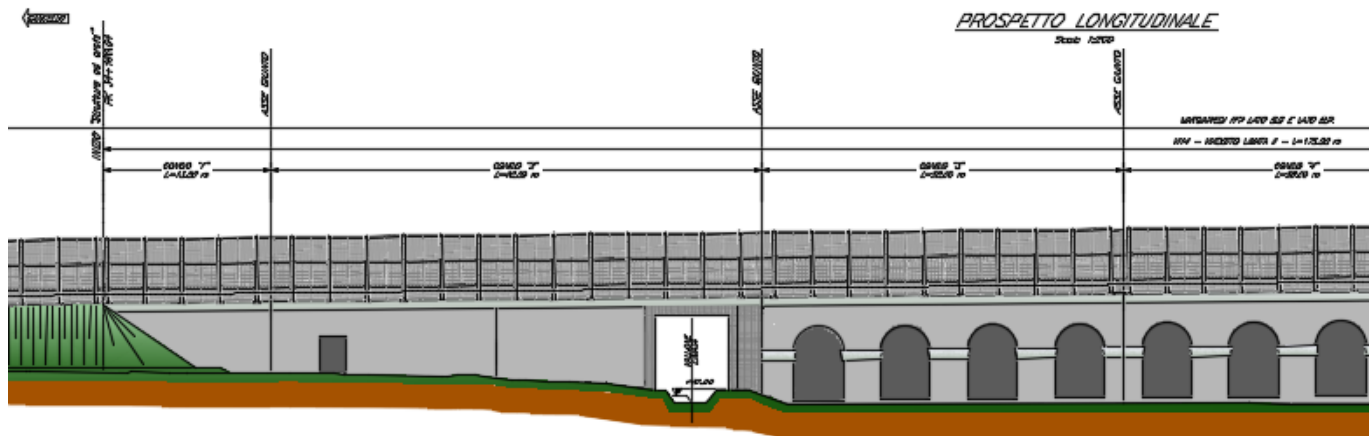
Prospetto del VI14 1 di 2 - "struttura ad archi"
